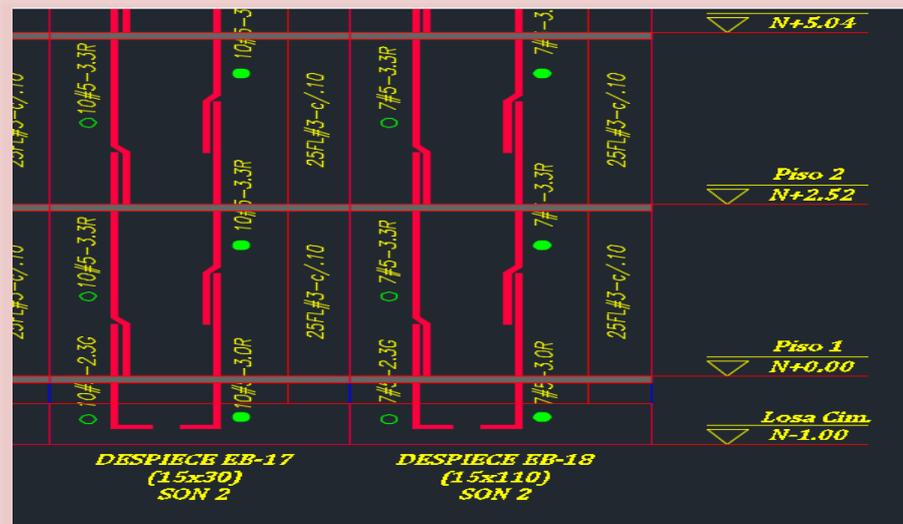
Refuerzo elementos de borde. Fuente: Planos estructurales Torres II
